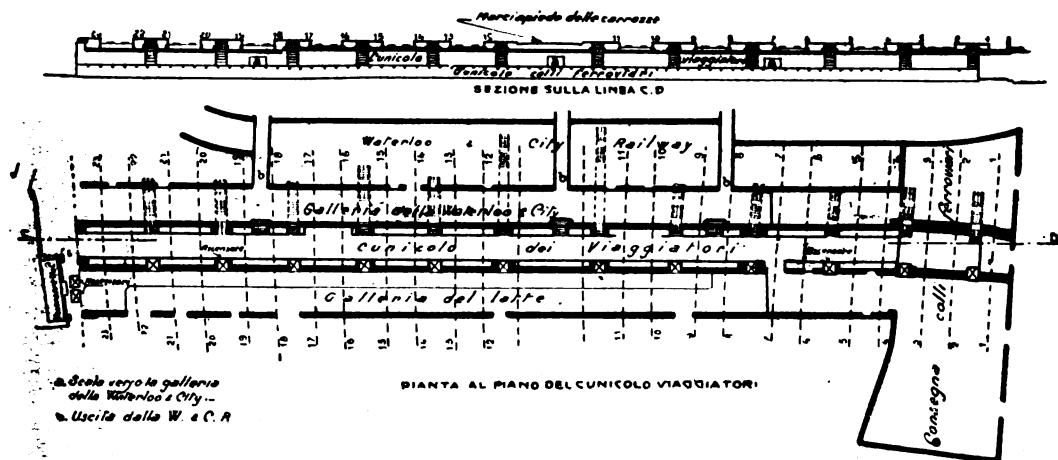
Sezione e pianta delle gallerie sottopassanti.
